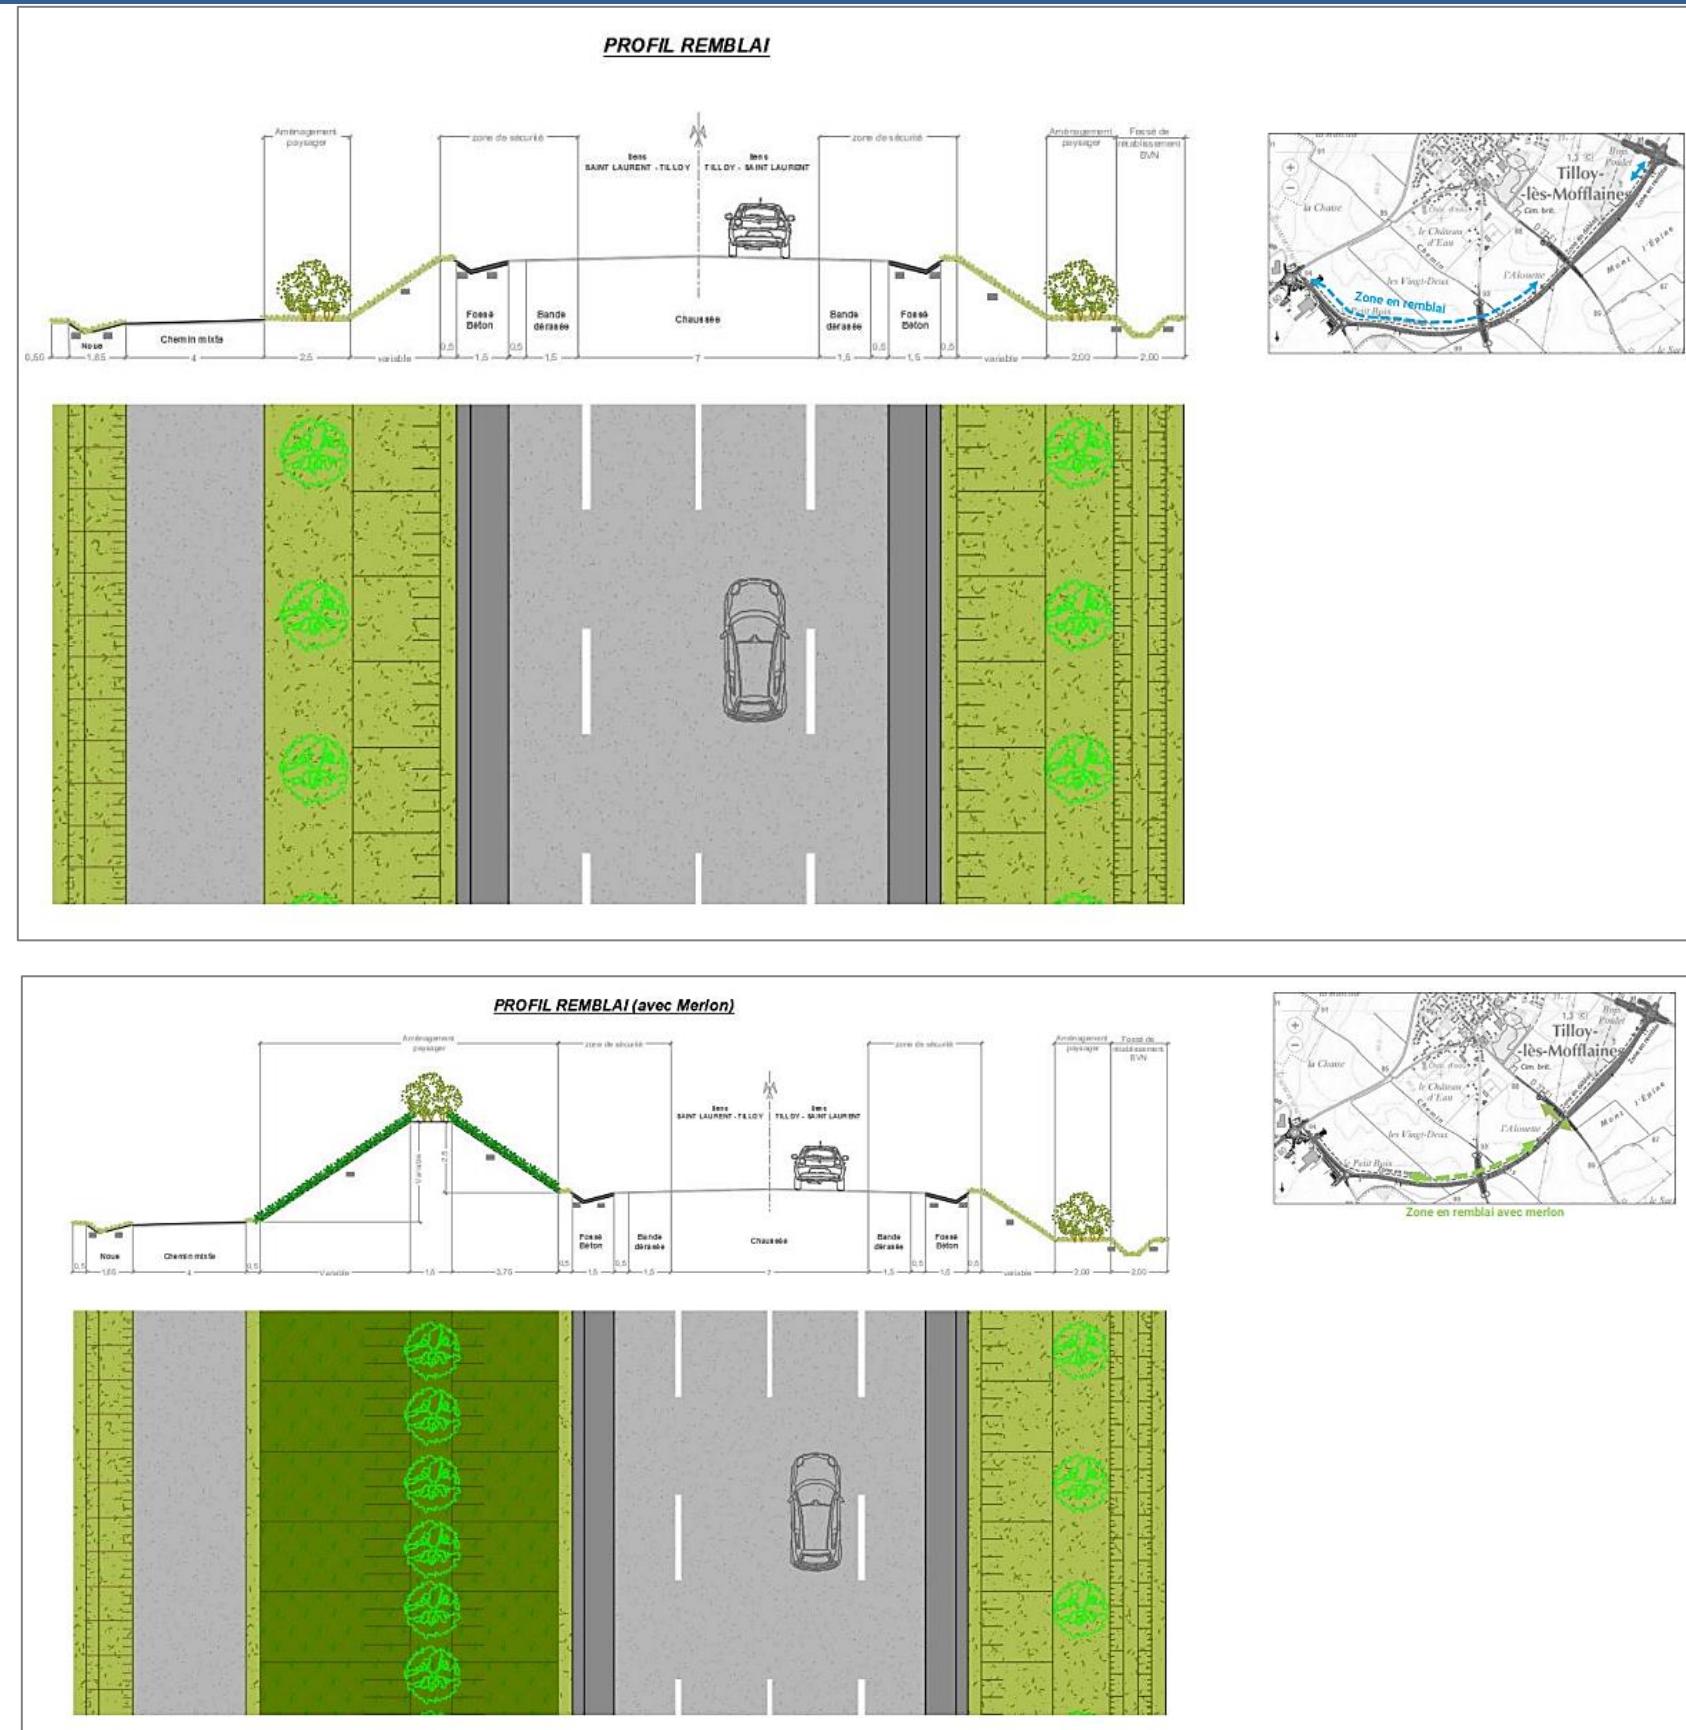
Profil travers de la section courante - en remblai avec et sans merlon
